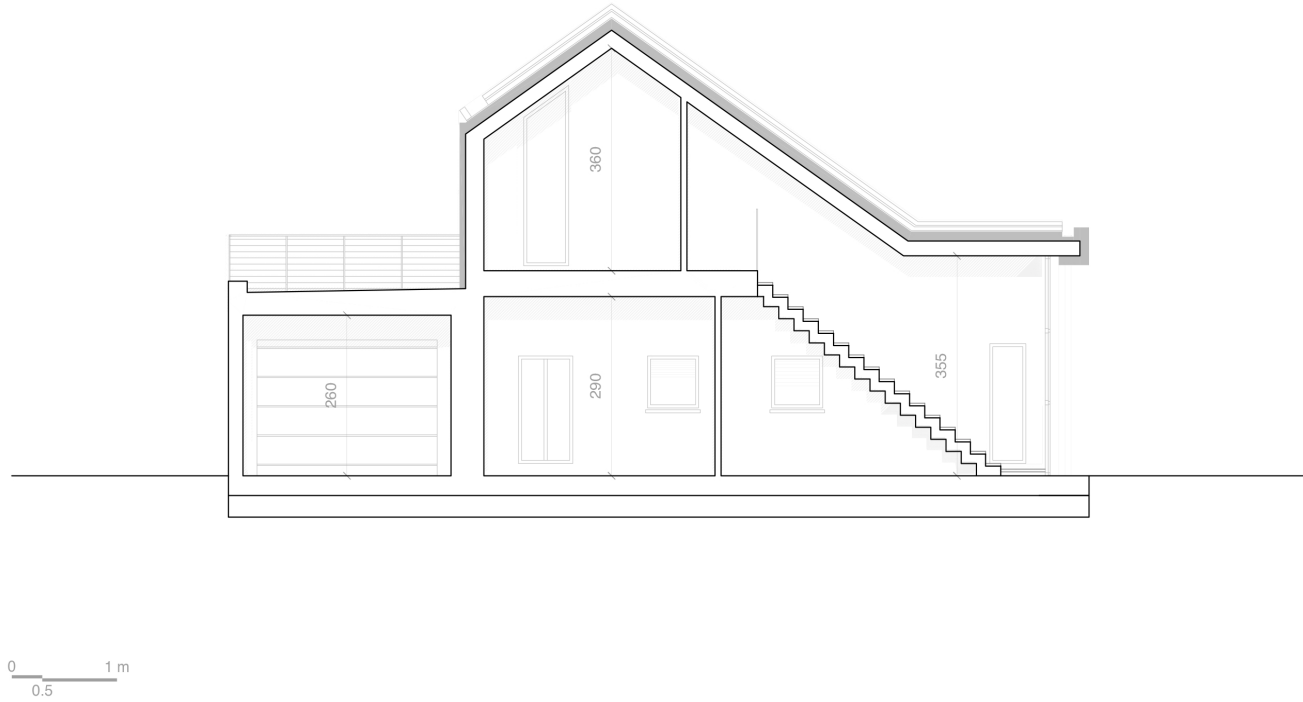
Restituzione da parte dell'autore della sezione principale della Biocasa Sarotto 2007
